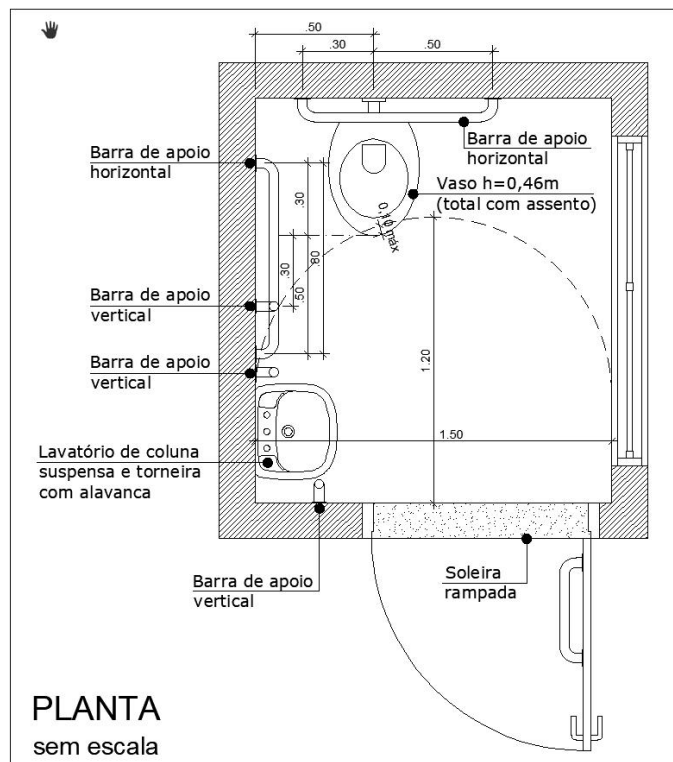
Modelo de sanitário acessível em situações excepcionais
